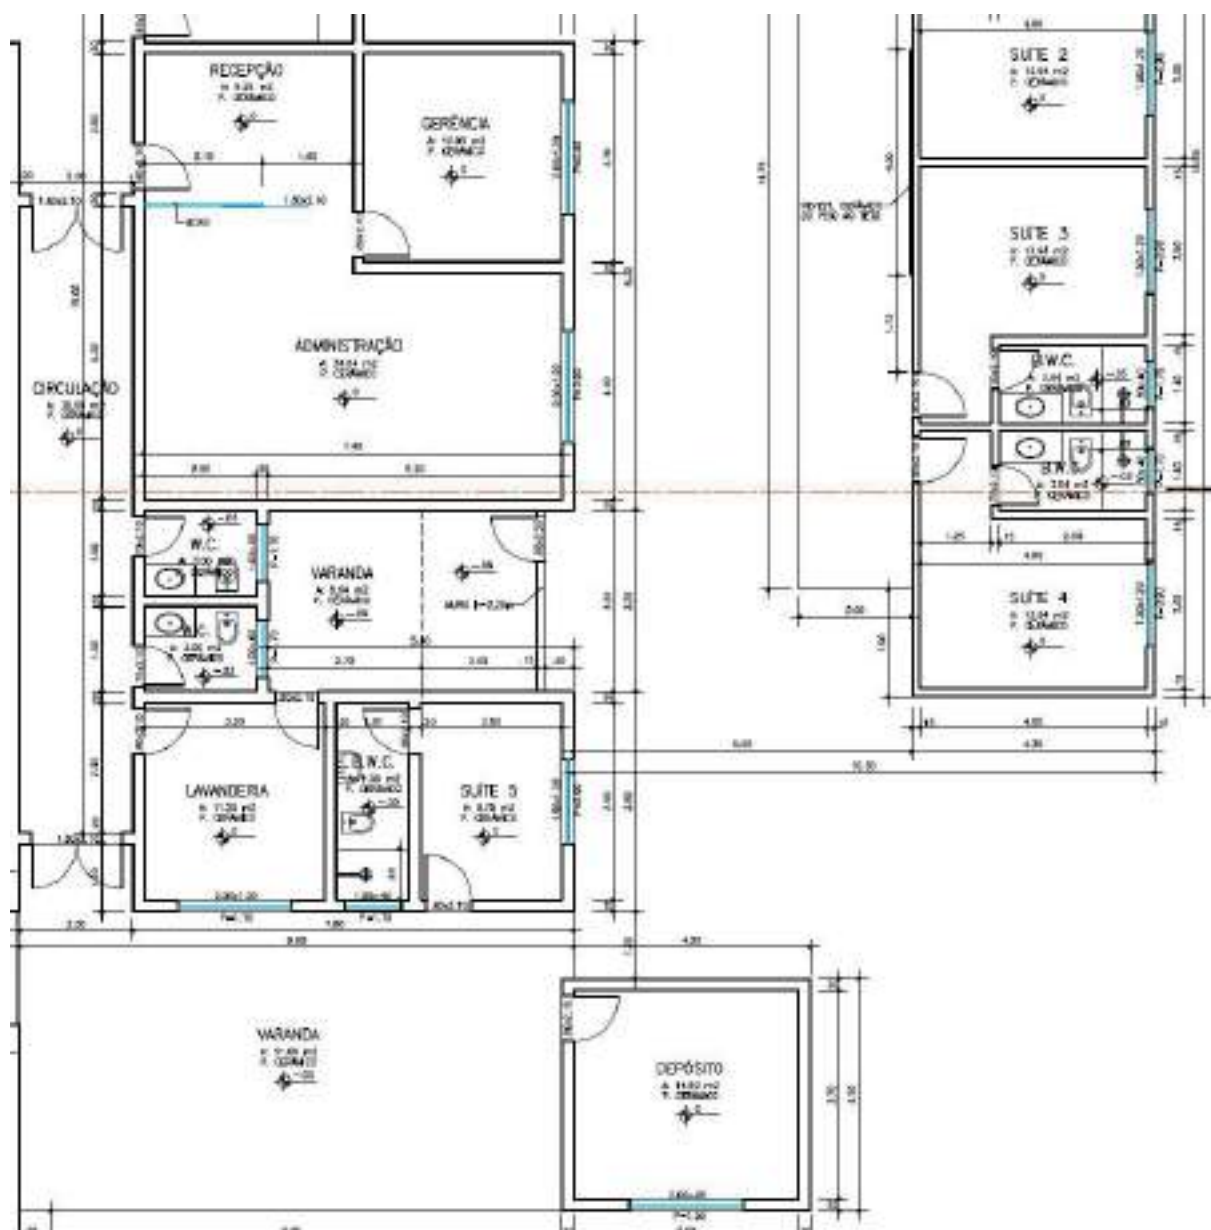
Partes da planta baixa geral da infraestrutura do velório.
